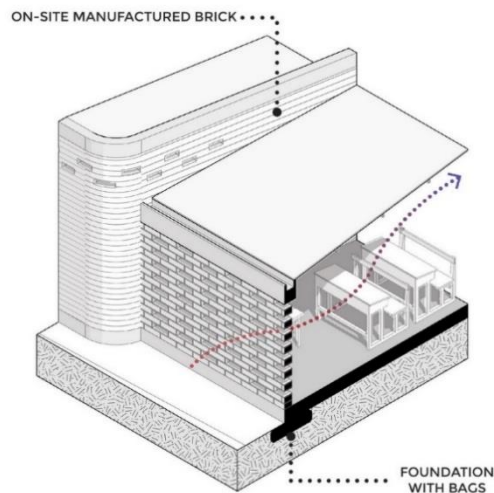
Módulo de aula, muro de trabajo abierto.
